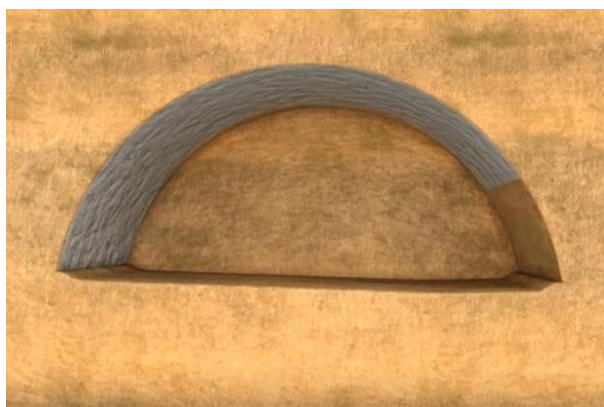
Primera capa de hormigón proyectado (Azvi studios, 2010)
